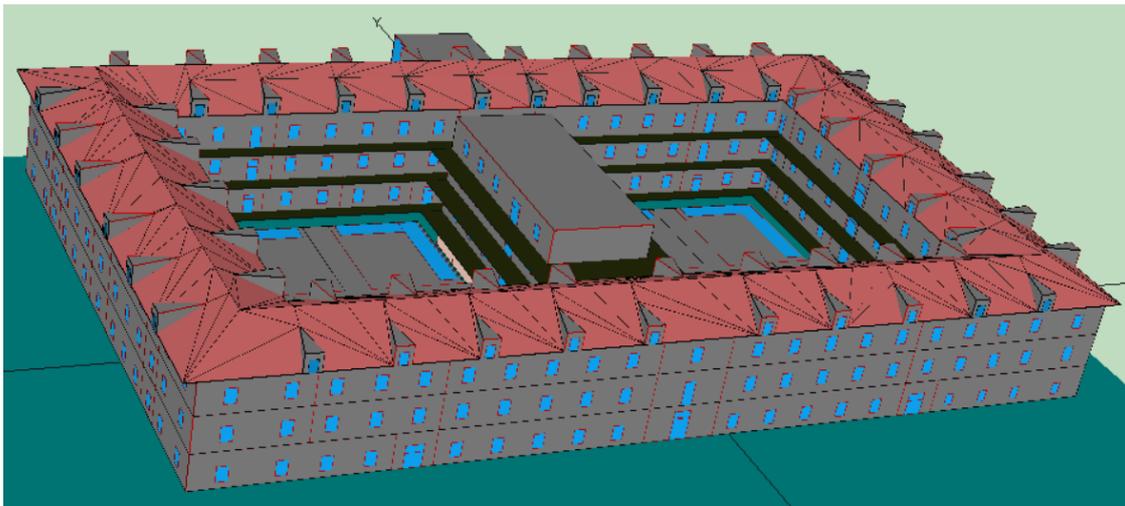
Edificio completo en LIDER, visto desde la fachada principal.
